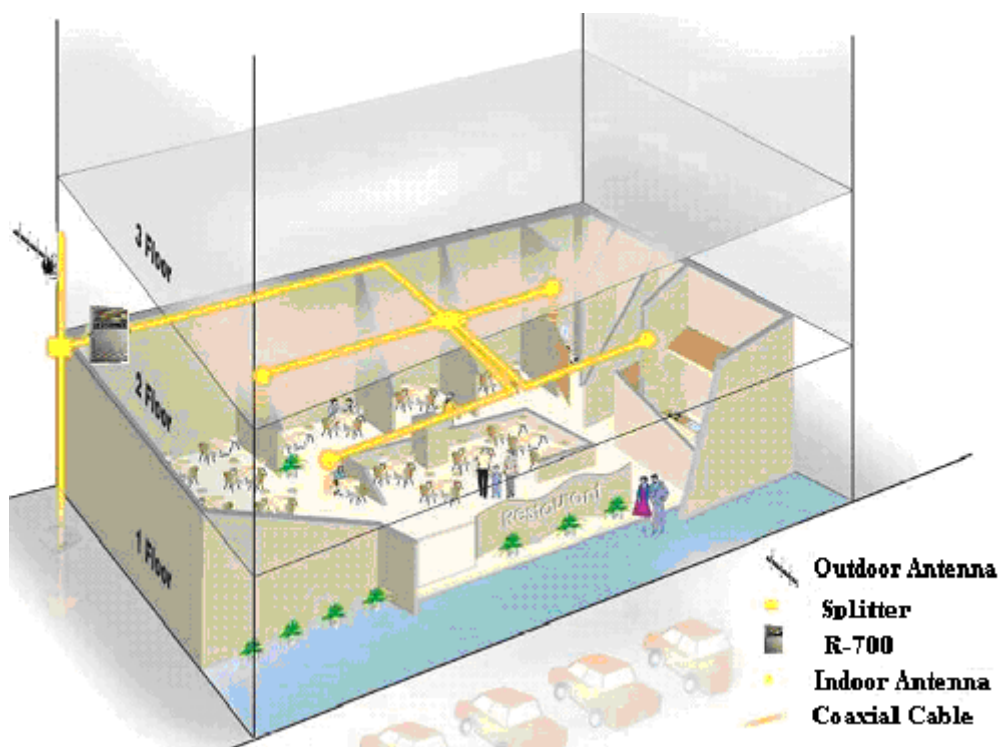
Здание с большой площадью и межкомнатными перекрытиями
